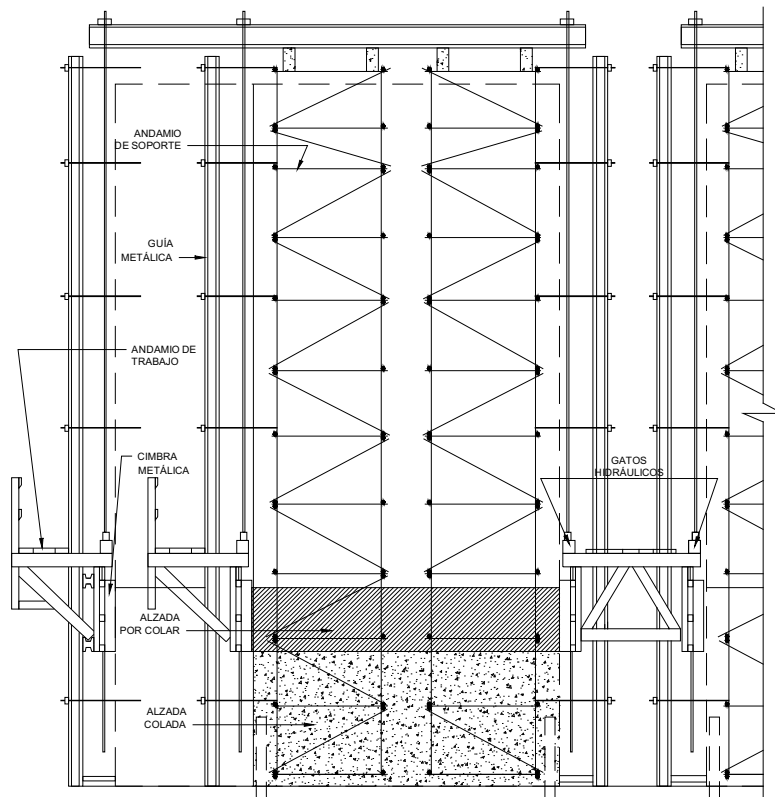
Zona de ubicación y disposición de la cimbra deslizante.
